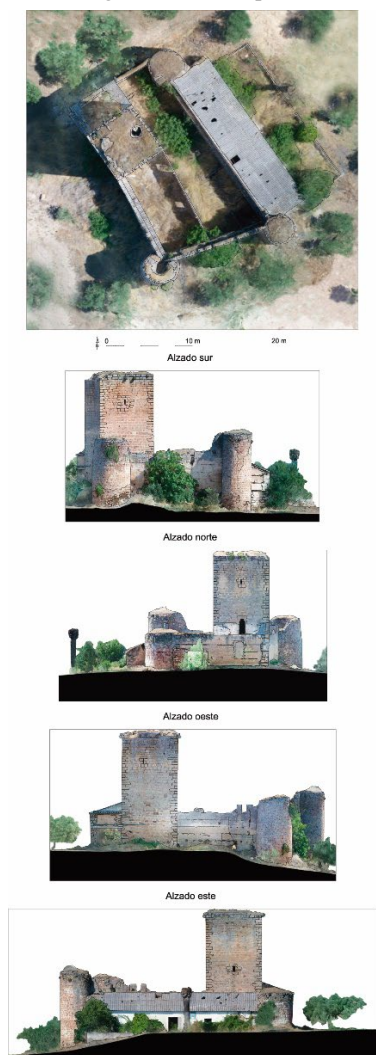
Ortofotografías de la planta y alzados exteriores del recinto de Aragonesa (autor).
